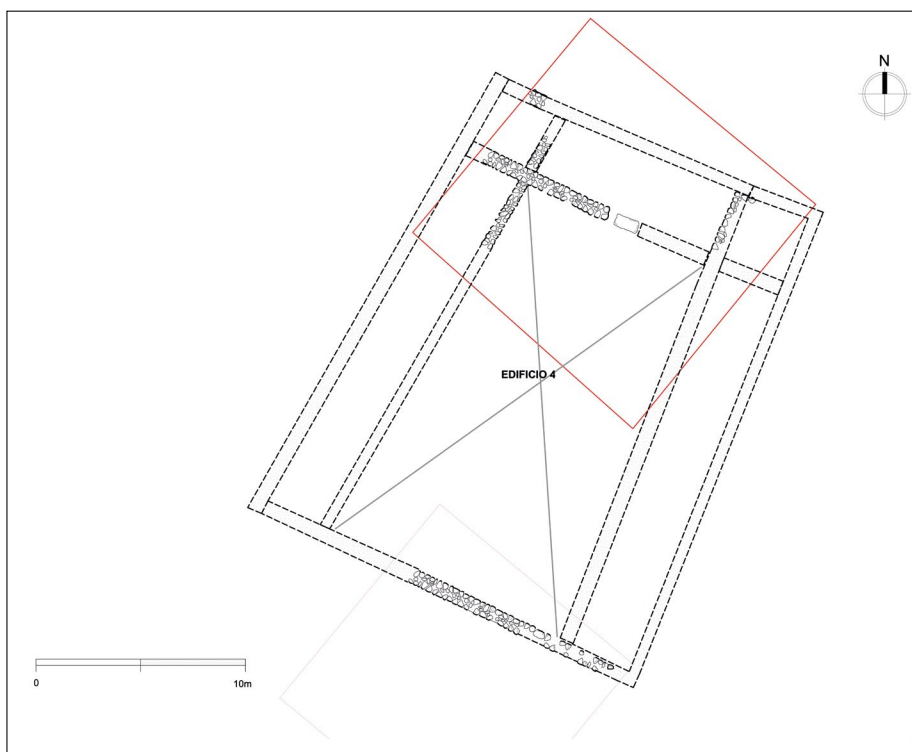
Planta arqueológica y reconstrucción hipotética del edificio 4.
